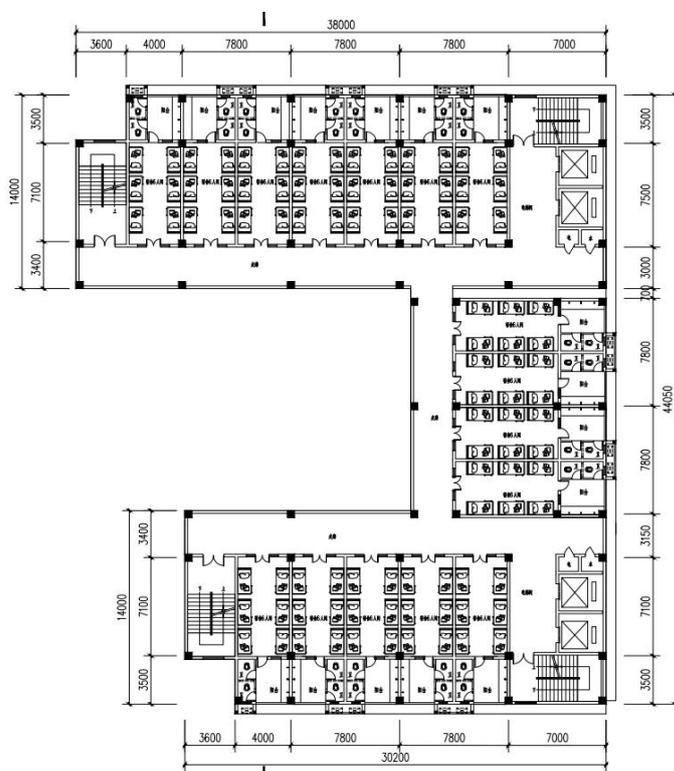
学生宿舍 4 号楼二至十二层平面布置图
